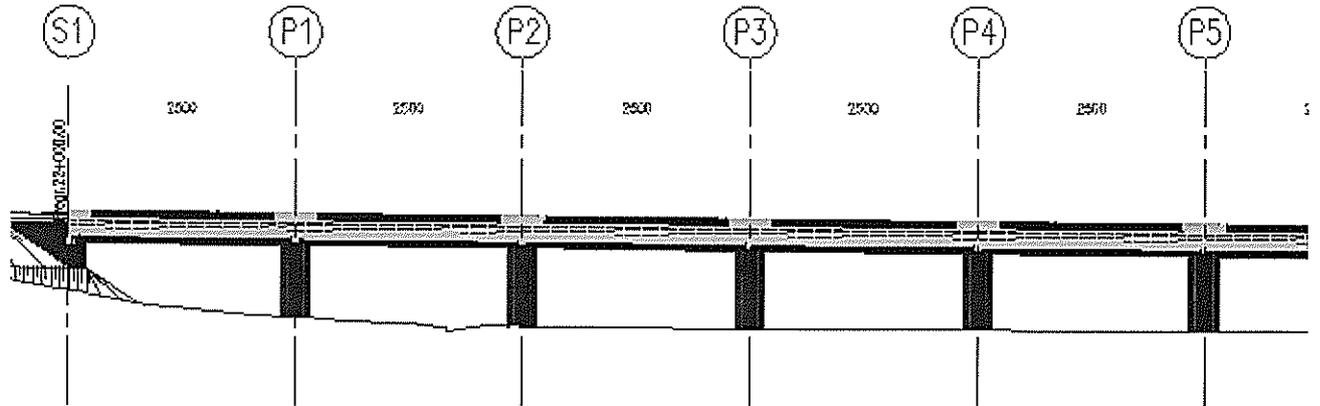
Viadotto Palude Capo d'Acqua: stralcio del prospetto
